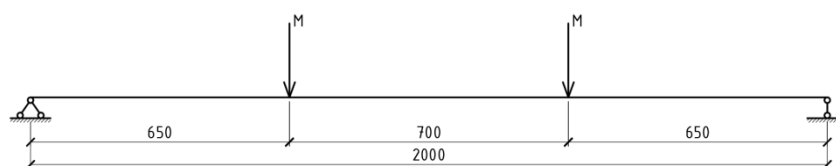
Опытные балки 1 по 4 с различными типами поперечного армирования
